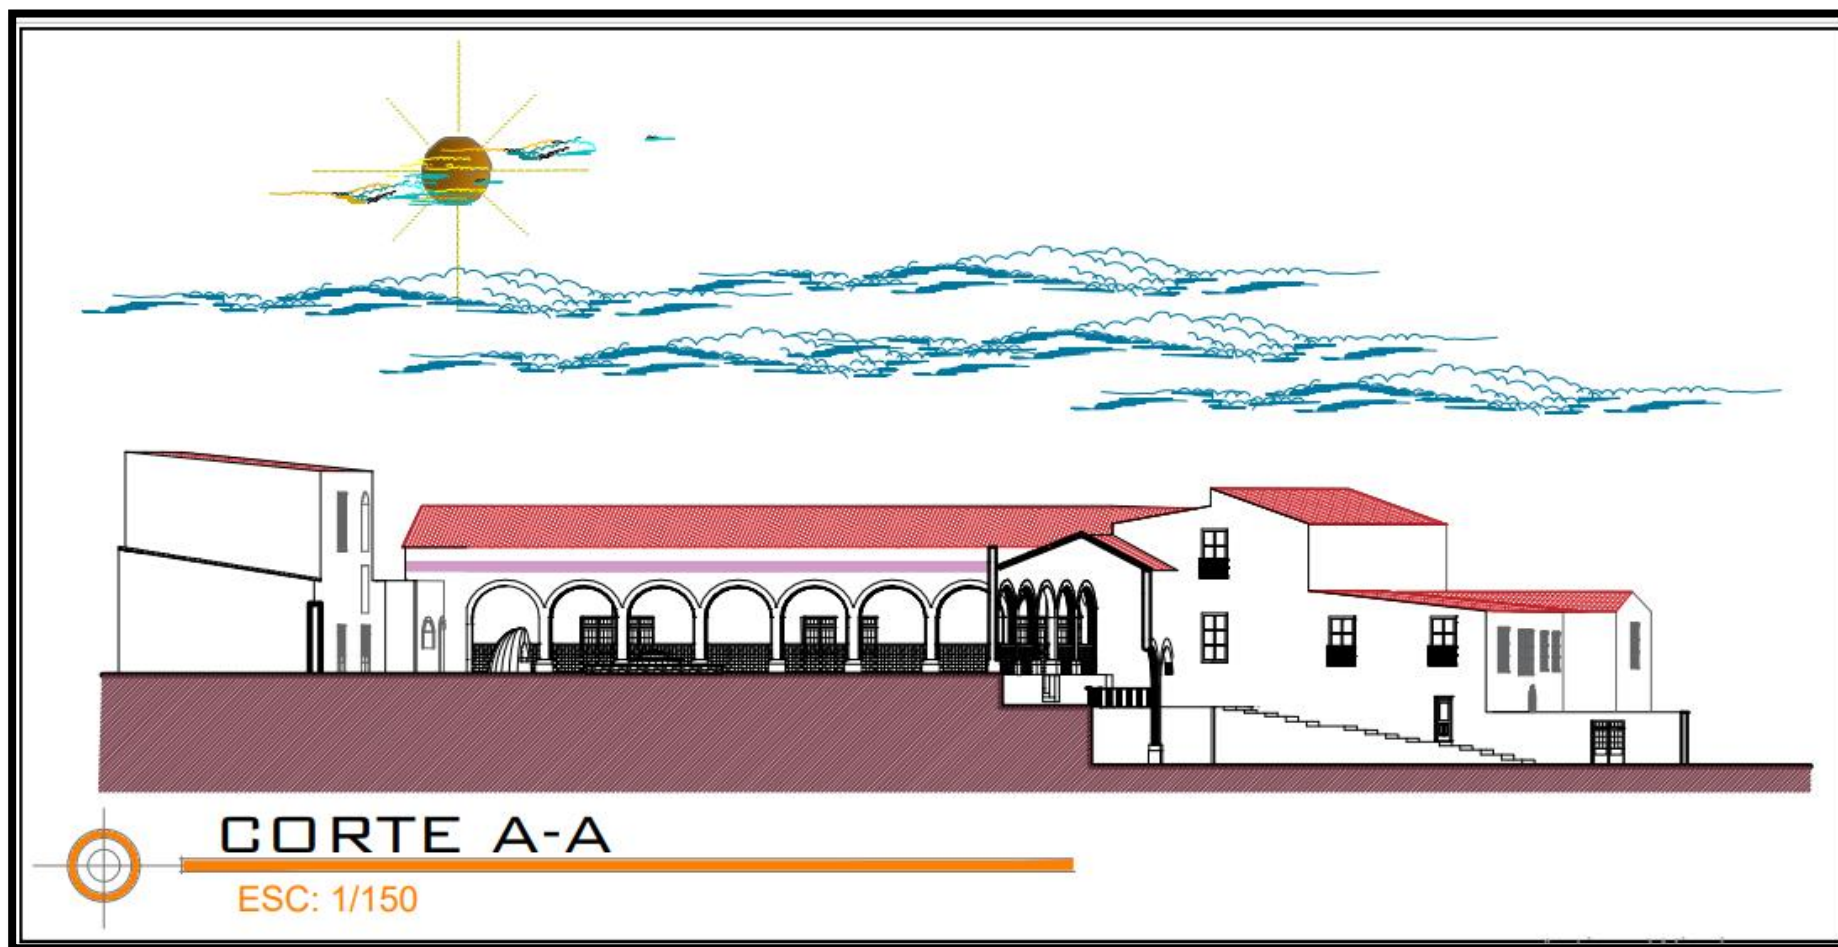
Plano de corte general de la hacienda Vichaycoto sección A-A.
